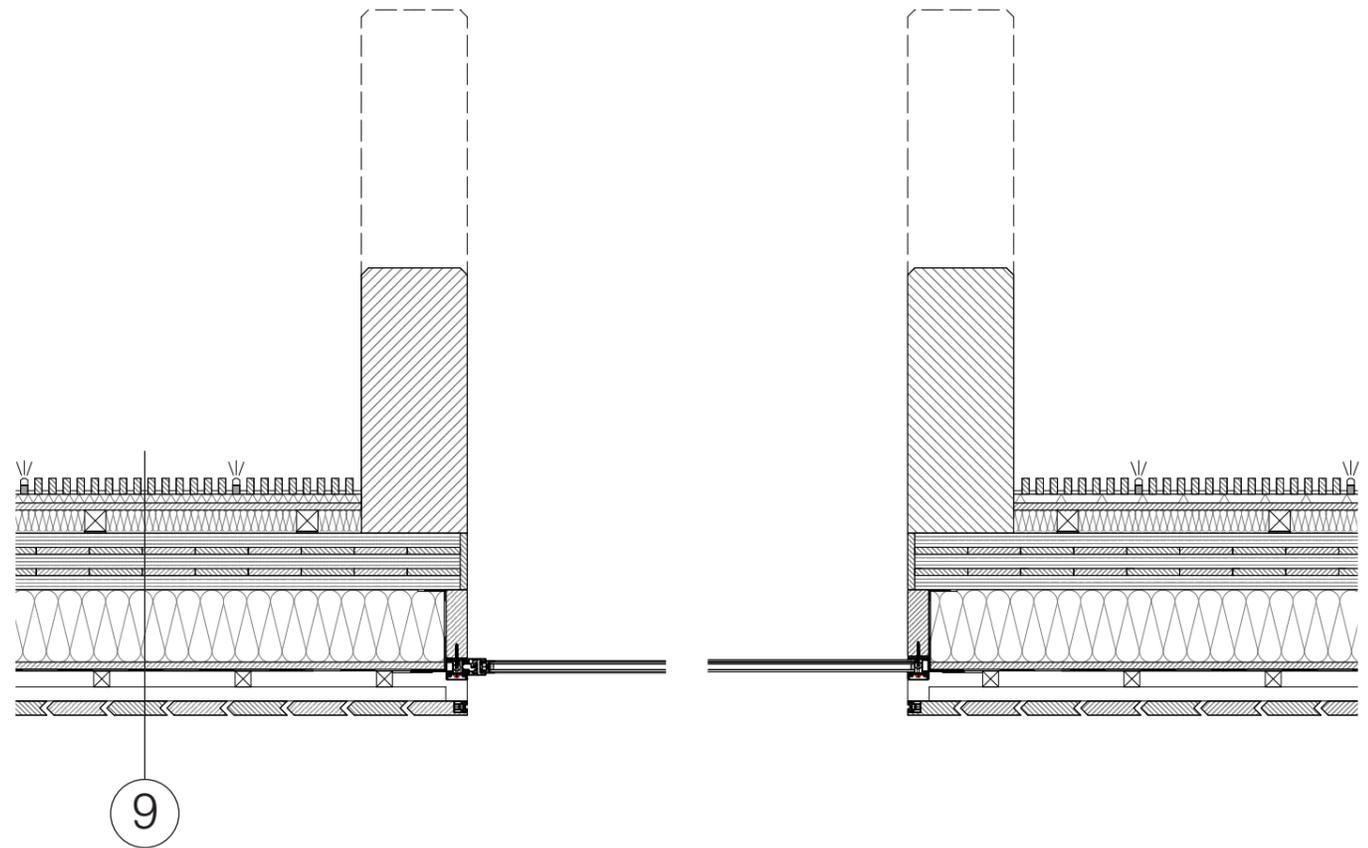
Fassadenschnitt 4 Fensterbanddetail 1:20
